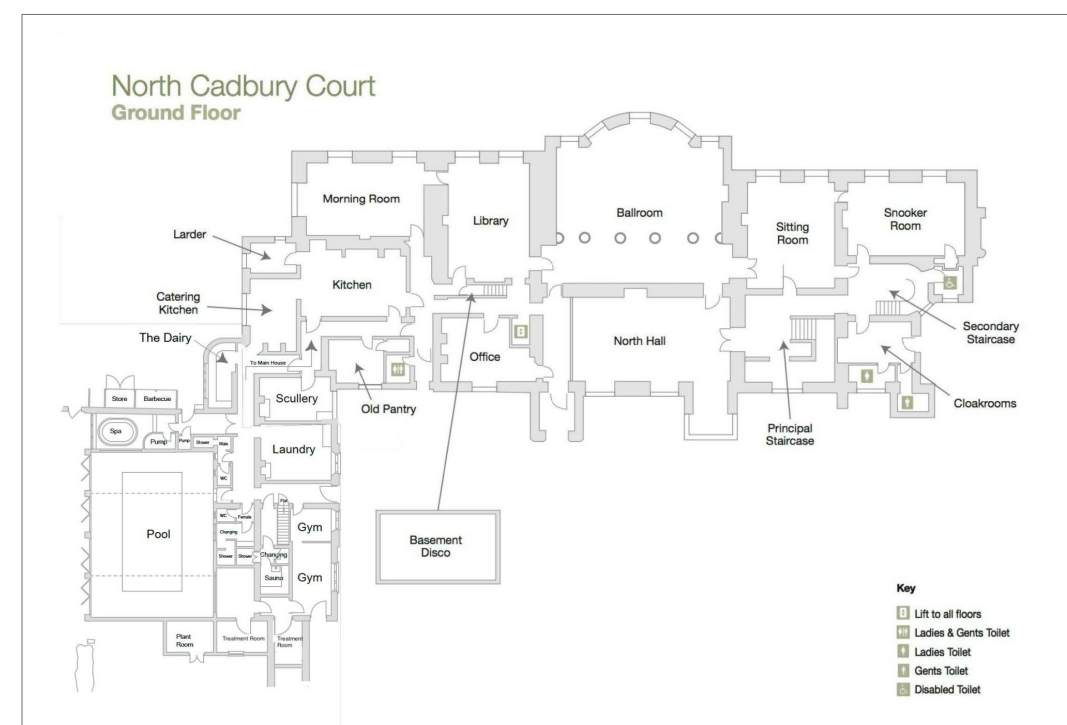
Plano de la planta baja de *North Cadbury Court*.
